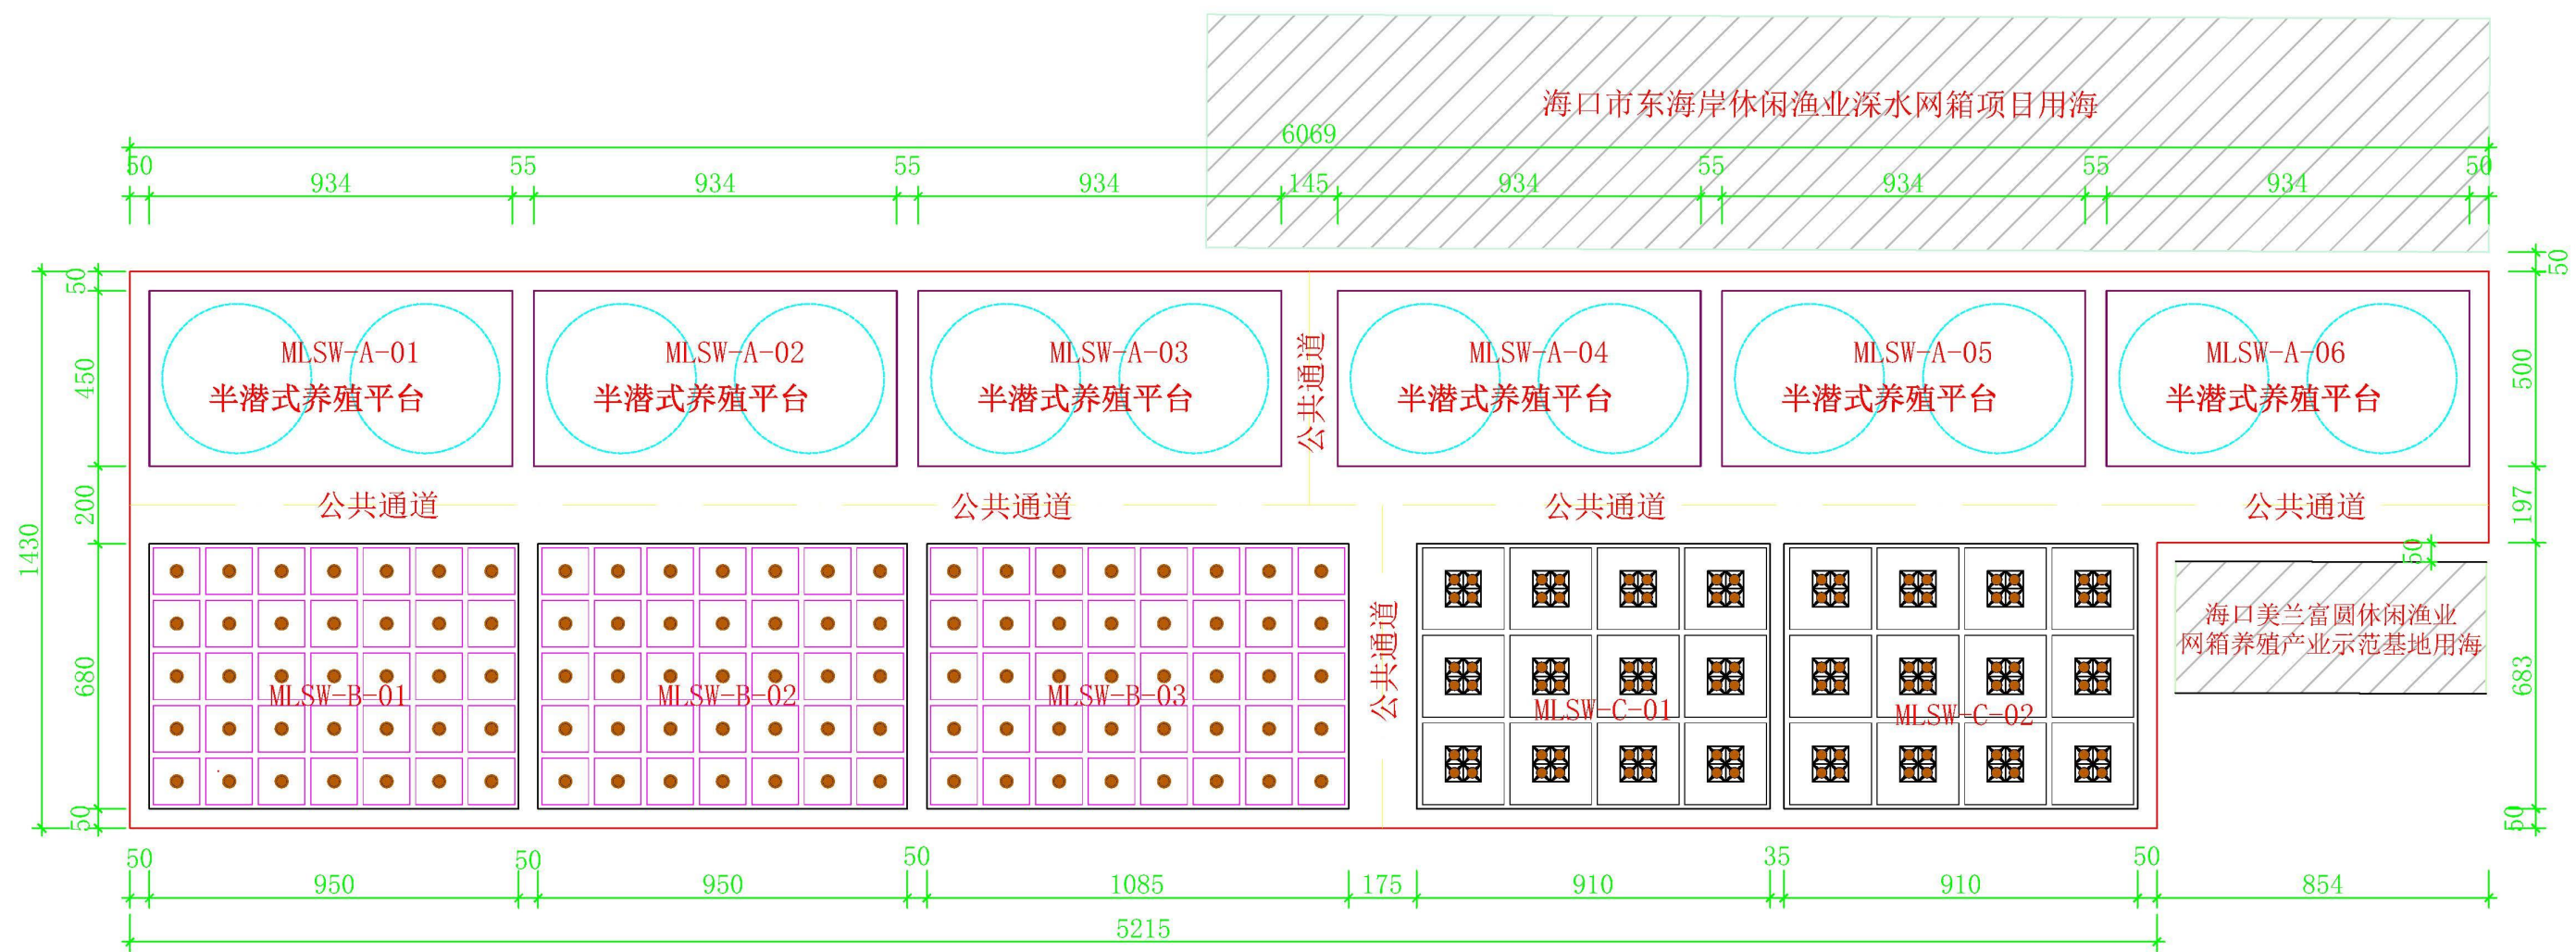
海口市美兰区养殖用海项目整体平面布置图
